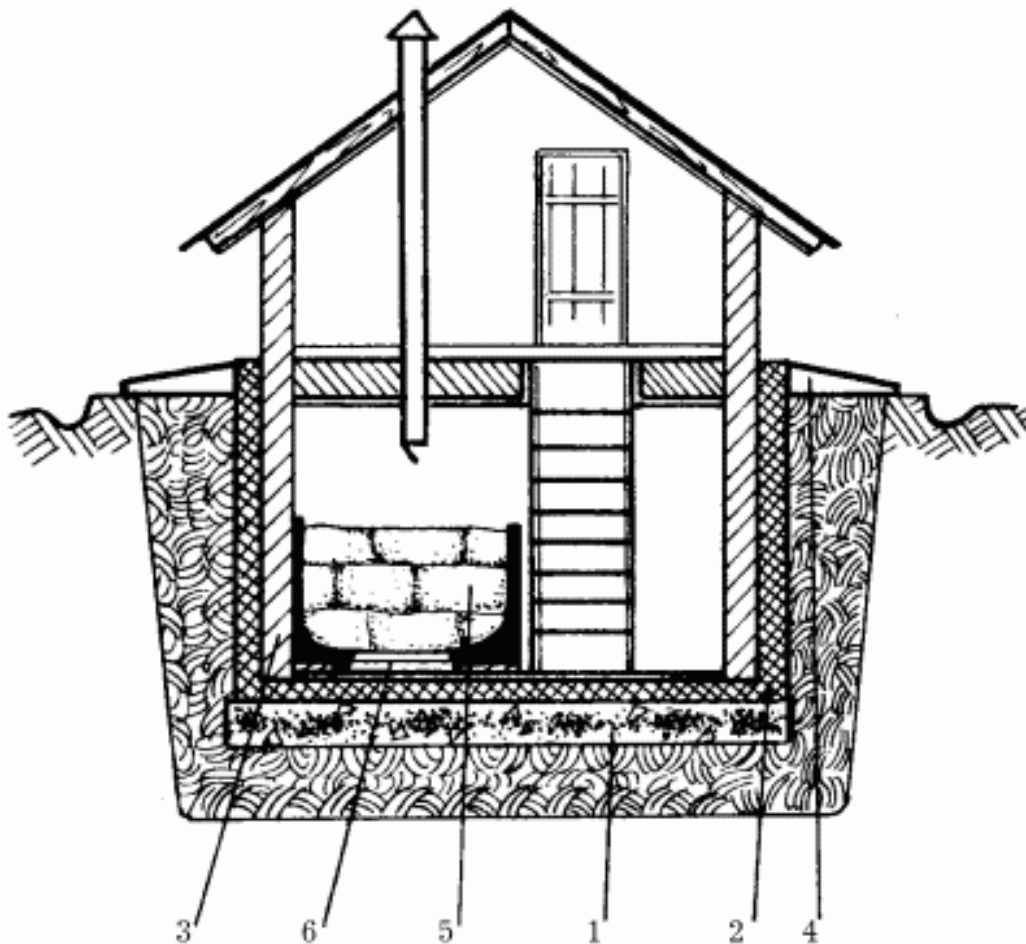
Погреб-ледник с погребицей: 1 – бетонное основание; 2 – гидроизоляция; 3 – стена ледника; 4 – отмостка; 5 – льдохранилище; 6 – поддон для сбора талой воды.
